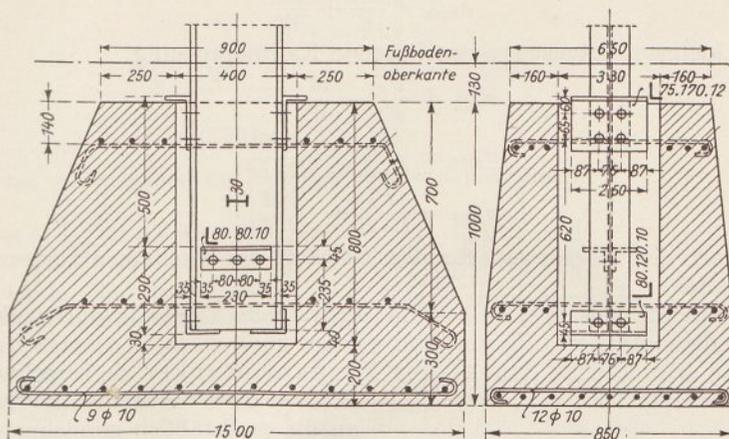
Biege feste Verbindung einer Stütze mit dem Fundament.
